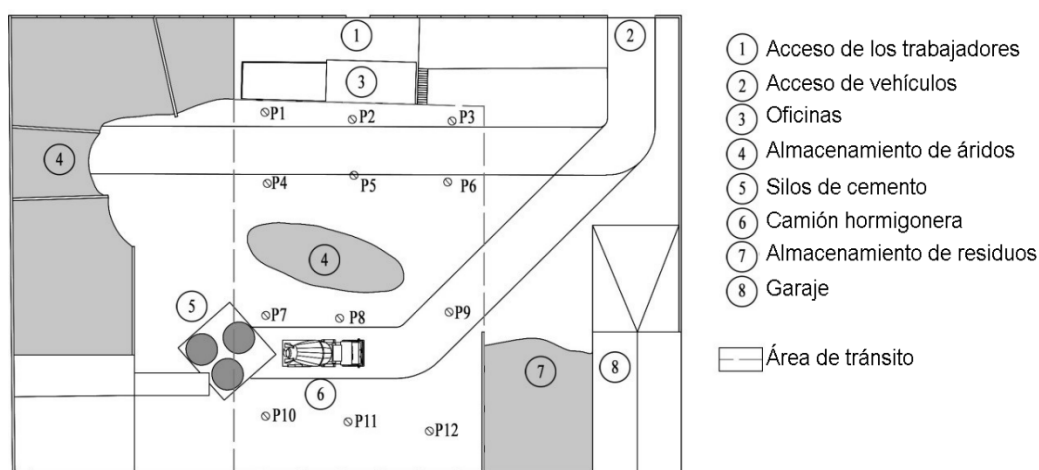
Distribución de las instalaciones en la planta de hormigón.
